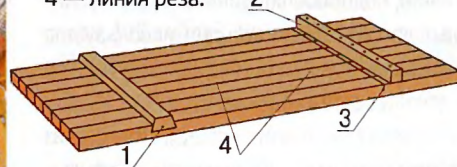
Сплачивание дверных полотен: 1 — шпонка; 2 — упорная планка; 3 — линия реза; 4 — доски щита.
